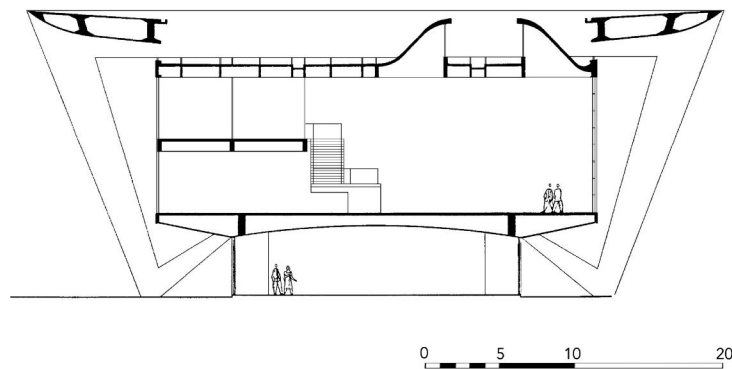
Corte transversal da galeria de exposições do MAM Rio.
